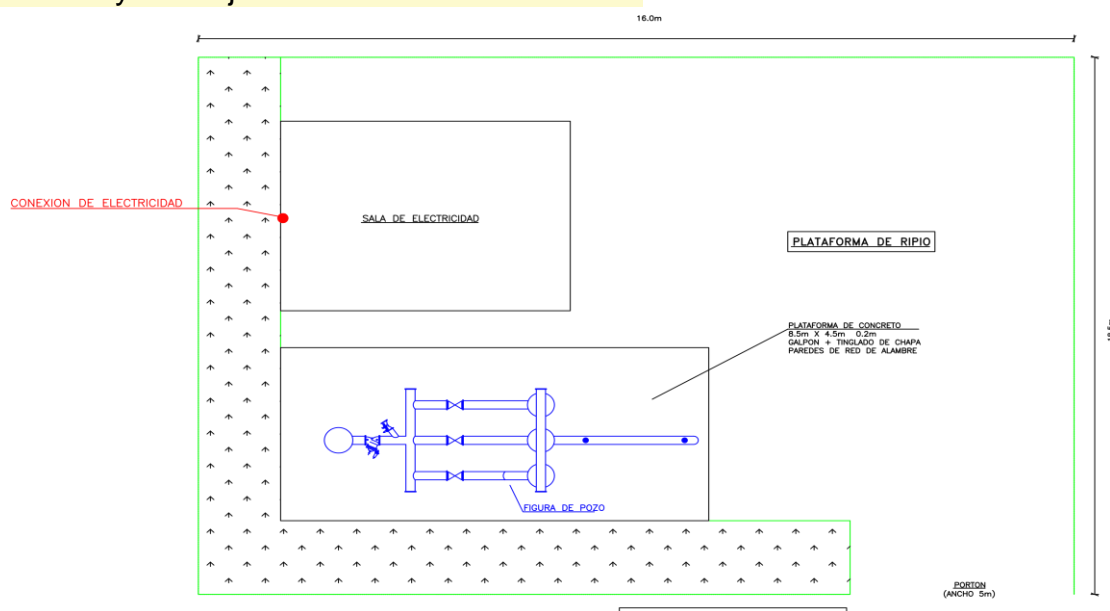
Esquema de casilla de protección. Elaboración Propia
